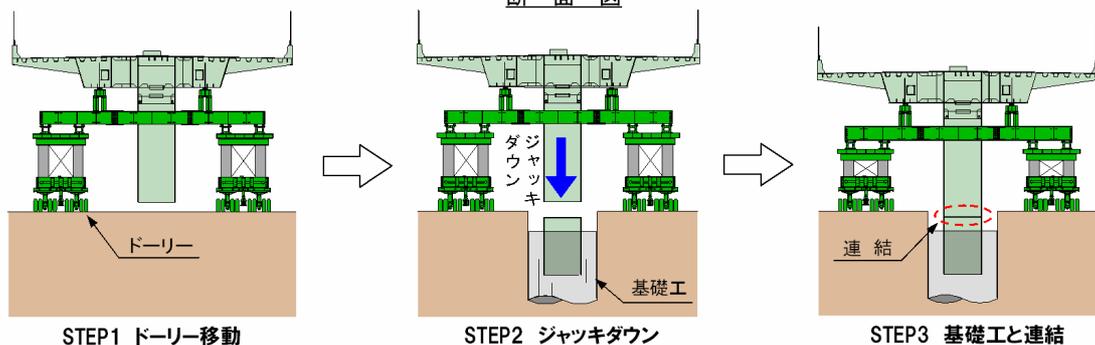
ドーリー一括移動の施工要領（P9～P10，交差点上）
